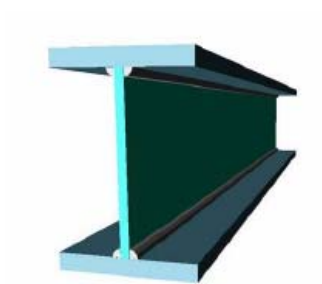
Perfil I soldado [SOUZA (2006)]
